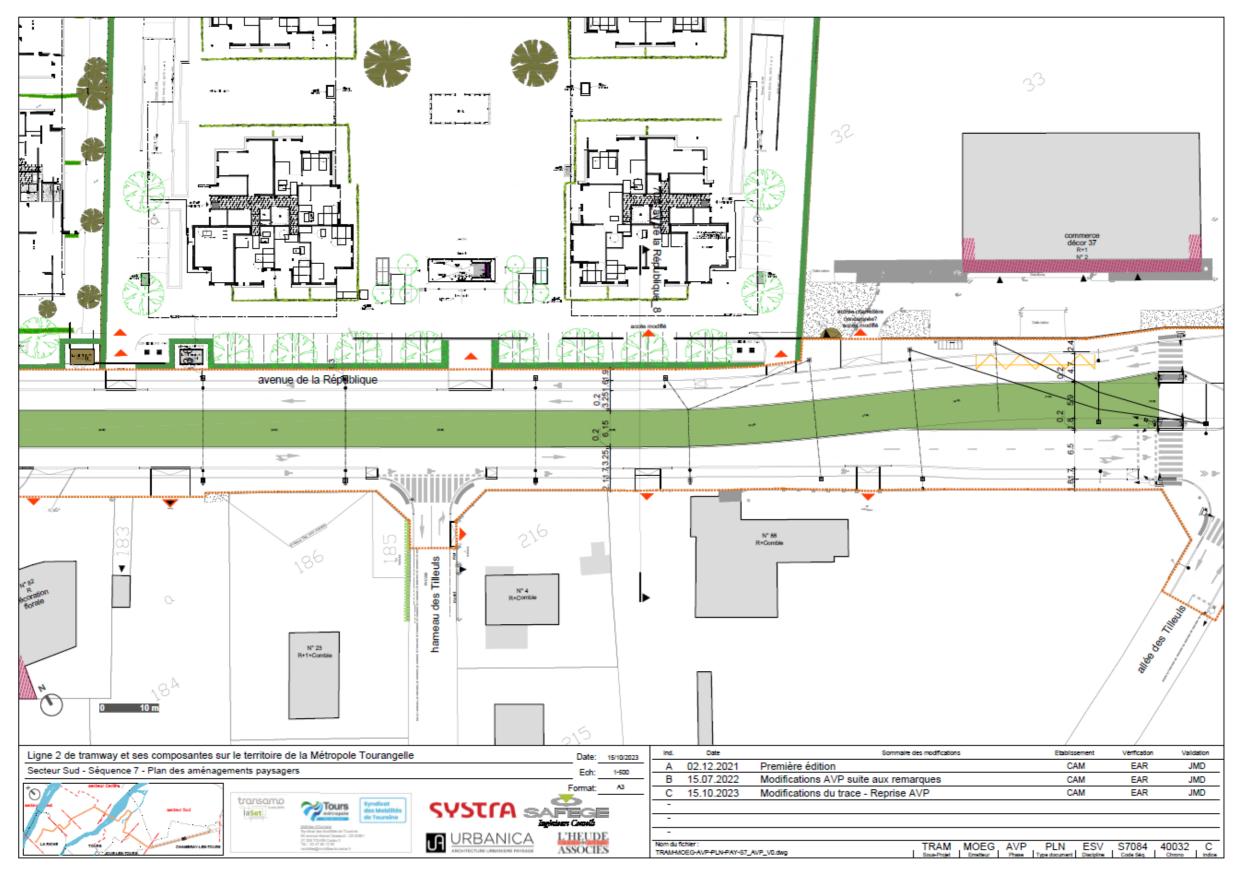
plan masse de localisation des arbres à abattre sur avenue de la République – Section 3 (planche 12)
